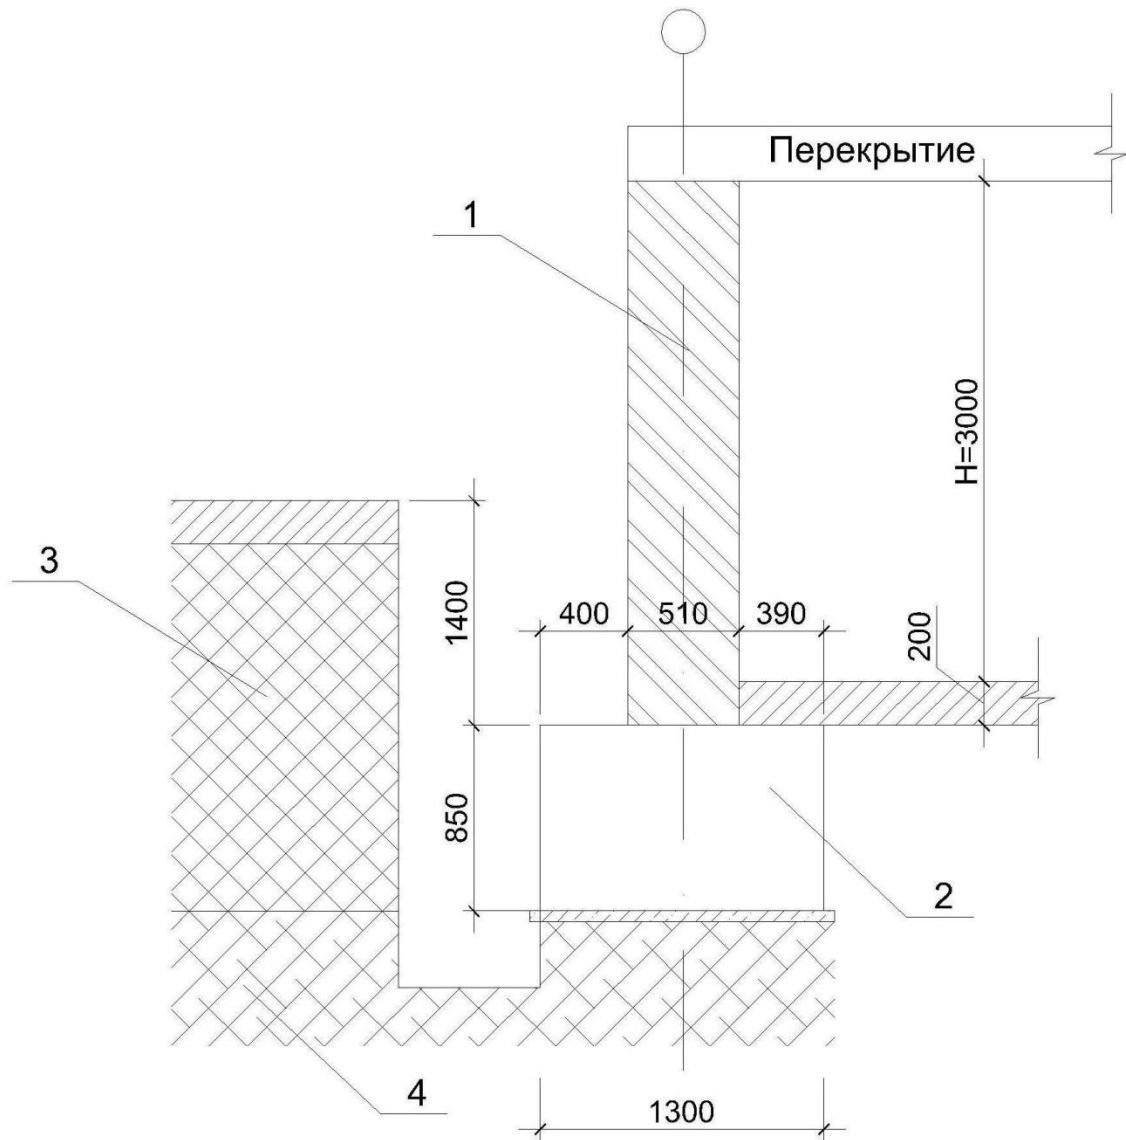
Фрагмент вскрытия №1 фундамента АБК
